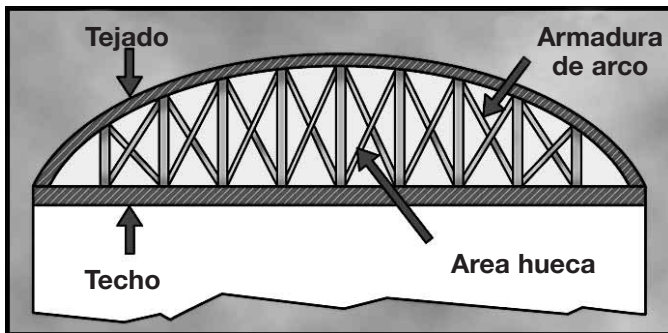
Observe las grandes áreas abiertas en la estructura armada del tejado.
